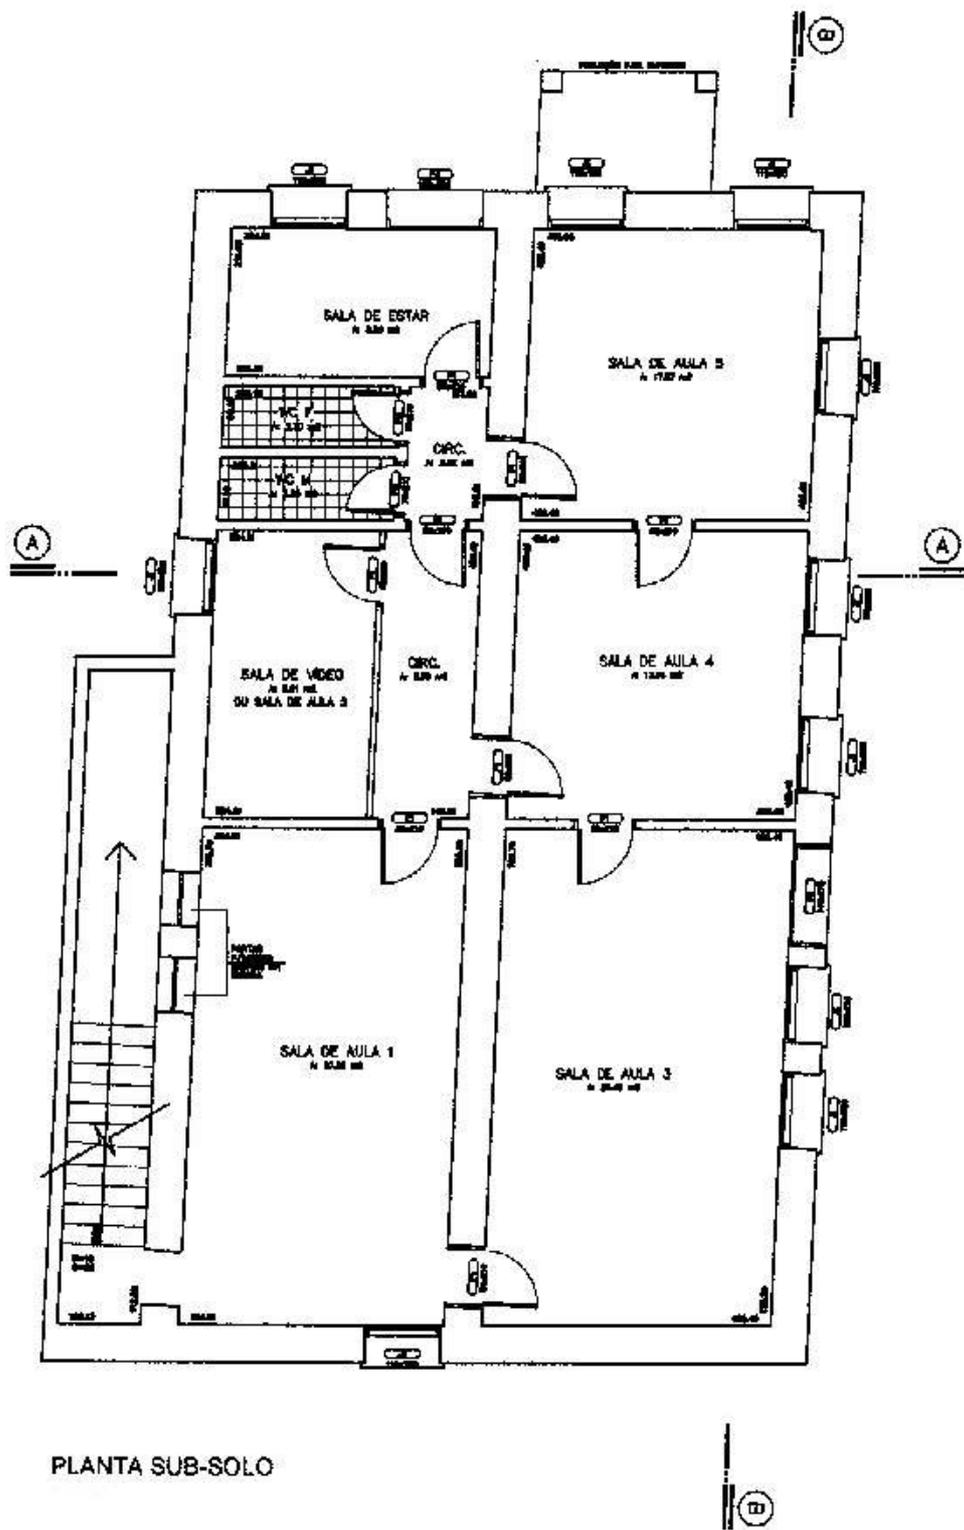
Planta atual da AISM (subsolo) - (fonte: José Zanella)
